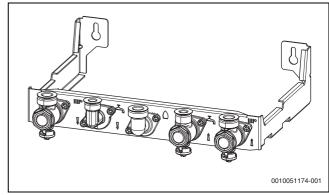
Montage des tubes avec les joints sur la plaque de montage pour le raccordement
